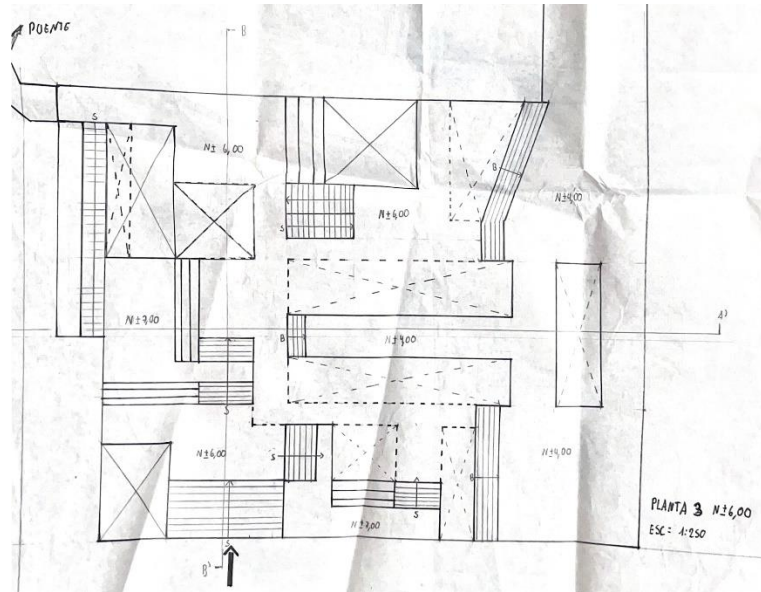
Dibujo mano alzada planta +6.00. Elaboración propia, 2024.
